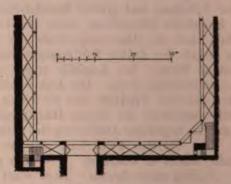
Grundriss des Schlosshofes zu Brieg.
